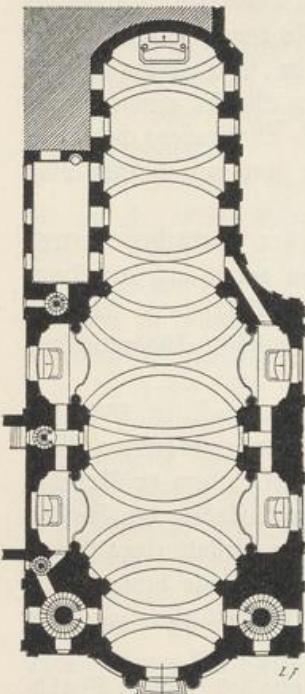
Grundriss der Kirche des Klosters Banz. (Nach Gurlitt.)
